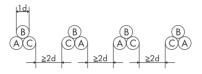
Disposición del cableado para cables de CA con una longitud inferior a 6 ½ ft. (2 m)
